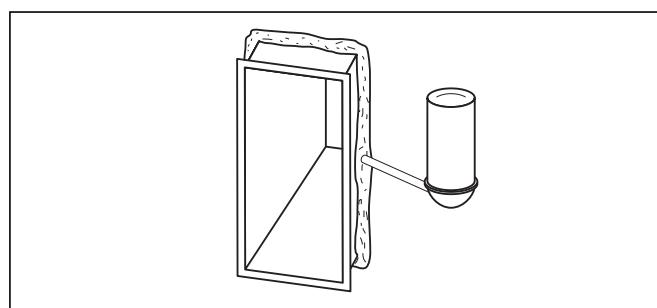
Wandöffnung mit Montageschaum abdichten
